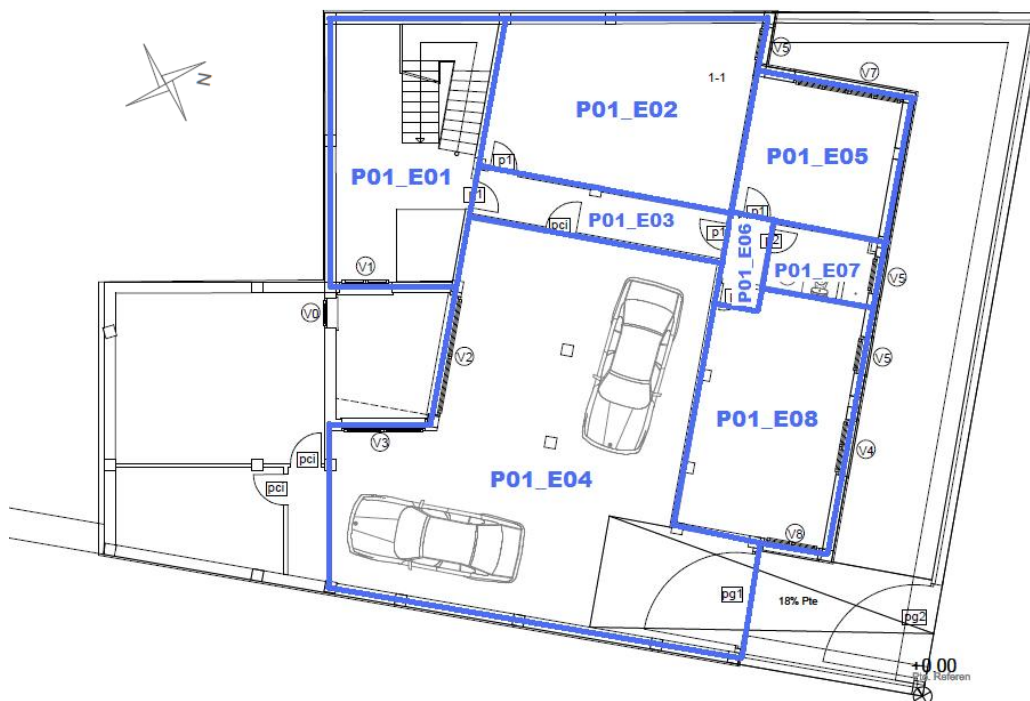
Planta sótano. Vivienda unifamiliar de Loja.
